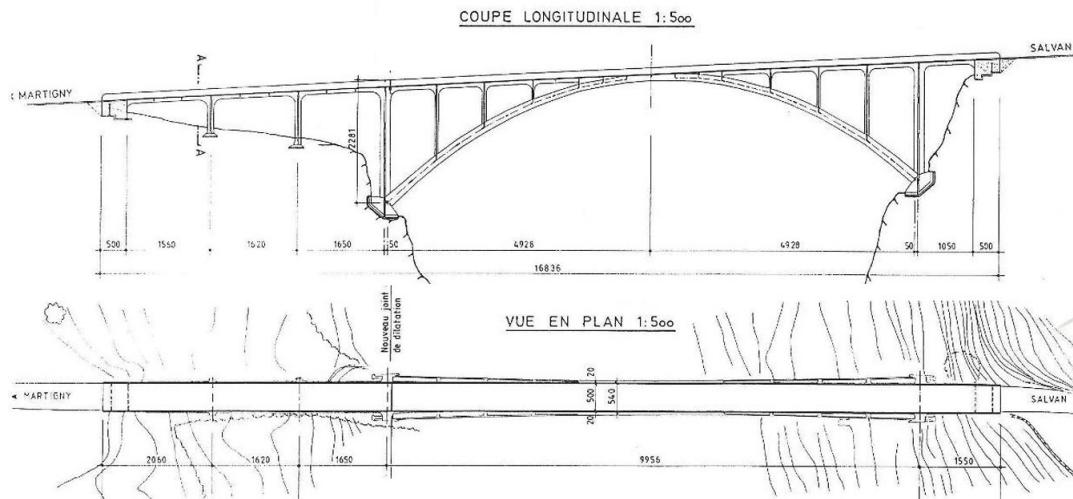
Pont de Gueuroz bei Martigny, VS - Längsschnitt und Grundriss
